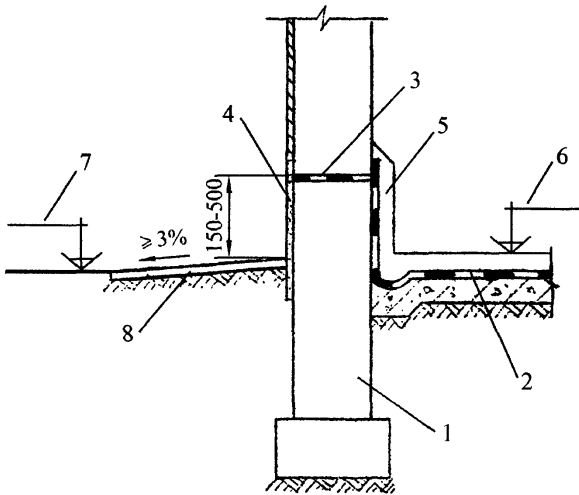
Устройство прокладок в стенах зданий без подвалов по поверхности стены
